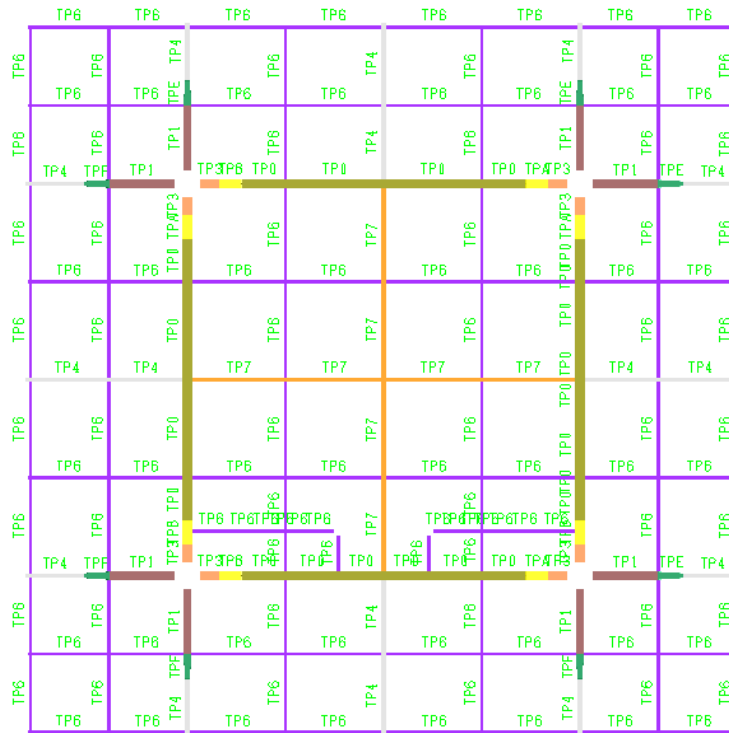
Elementi orizzontali a sezione aperta - impalcato Quota 15 m
